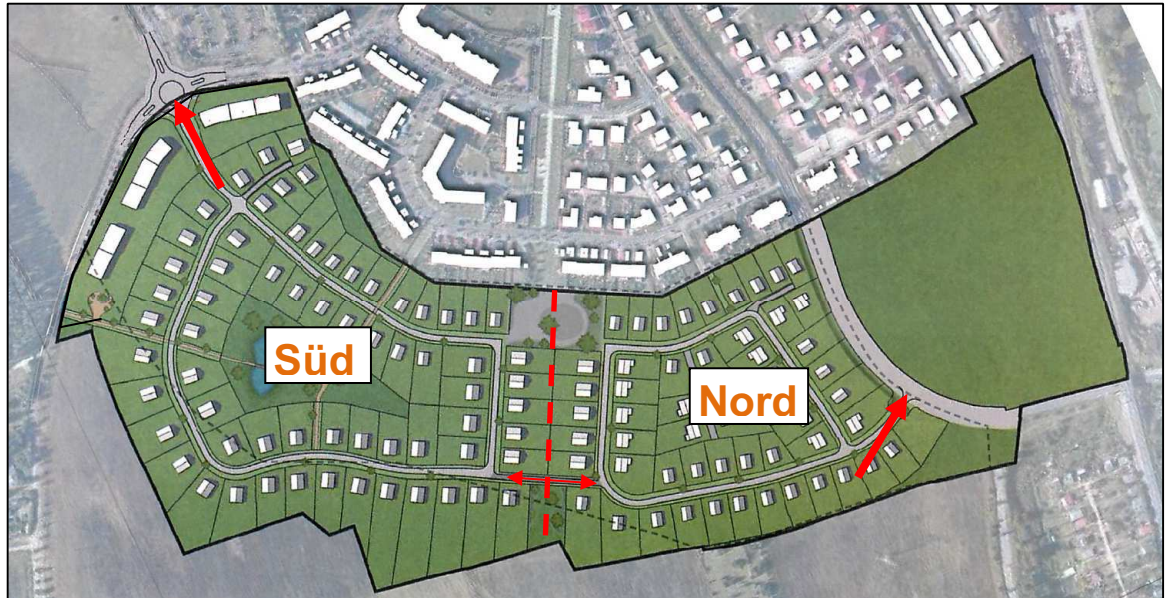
Städtebaulicher Entwurf Bebauungsplan Nr. 24a (Quelle IGN)
